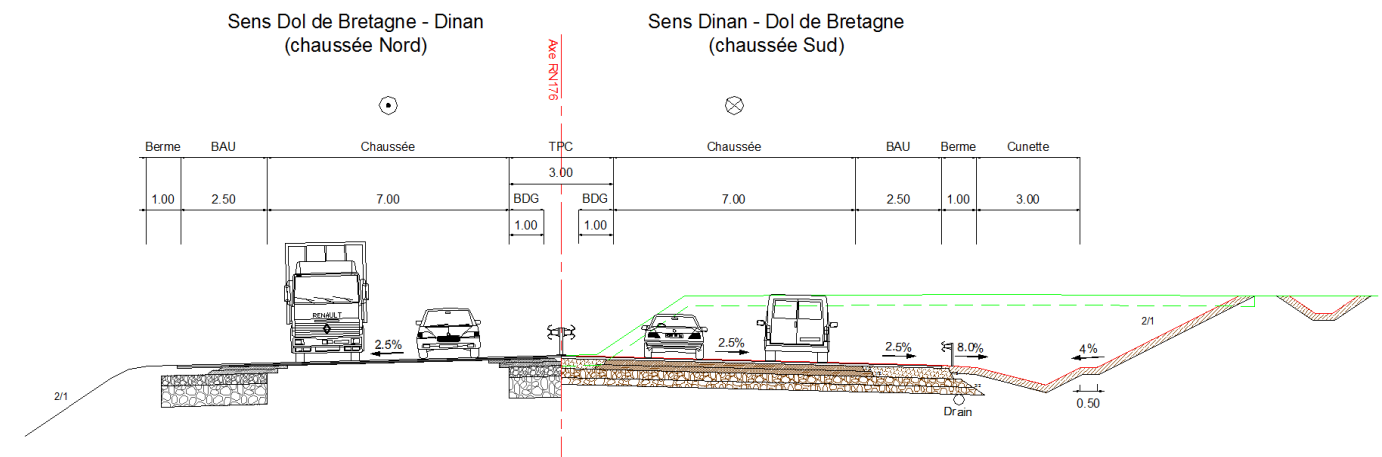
Profil en travers de la section courante en déblai (source ARCADIS)
